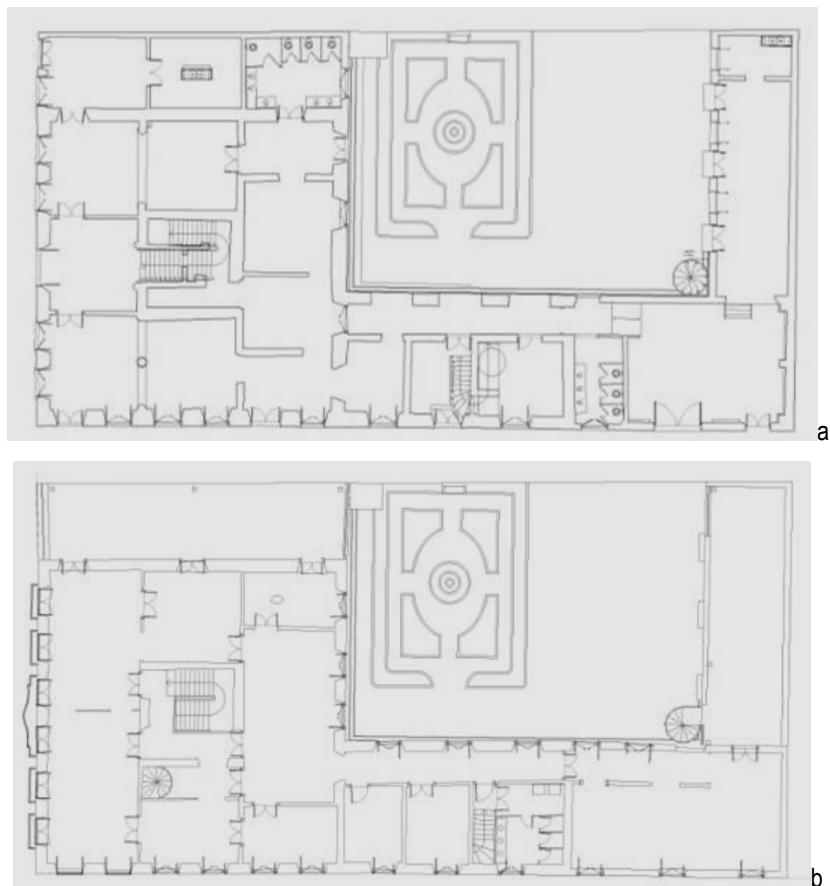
a) planta baixa térreo e b) planta baixa 2º pavimento. Fonte: Secretaria Municipal de Cultura, [s.d.].
